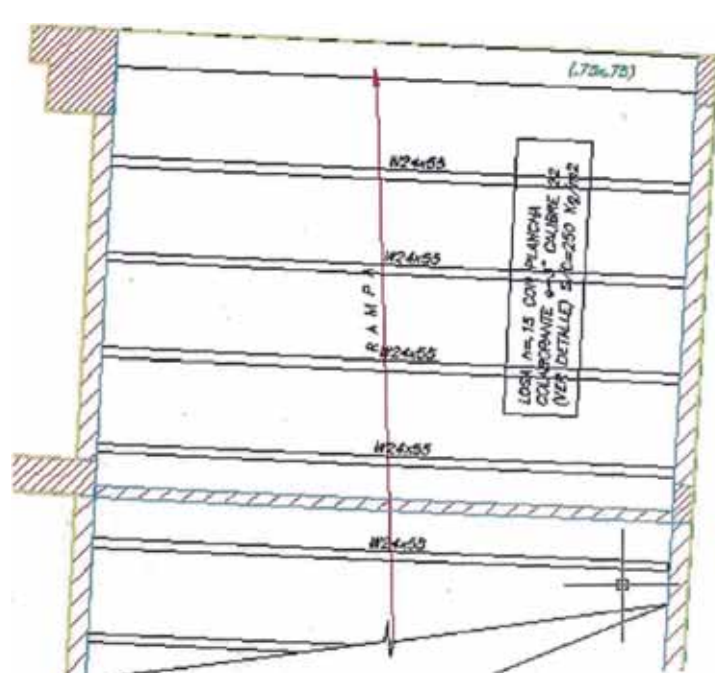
Vista en planta de la rampa -Fuente: Planos de arquitectura del proyecto
